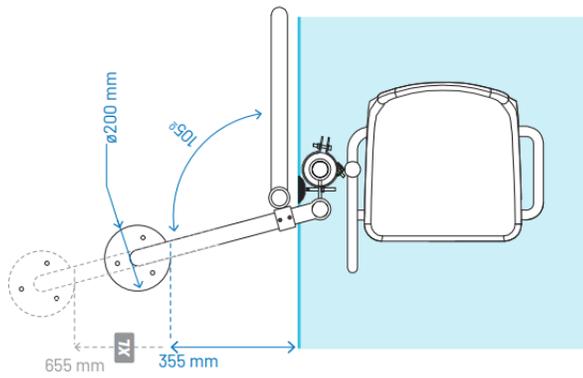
Vista en Planta Brazo Hidráulico – Piscina.
